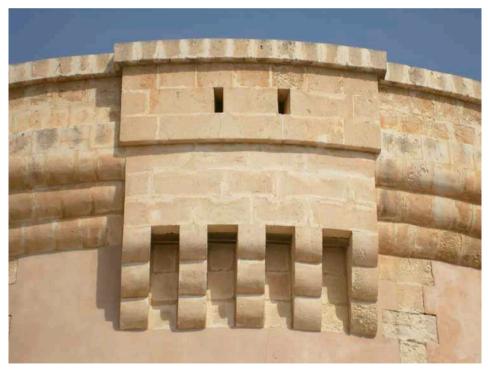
Vista del matacán de la torre, después de la restauración.
